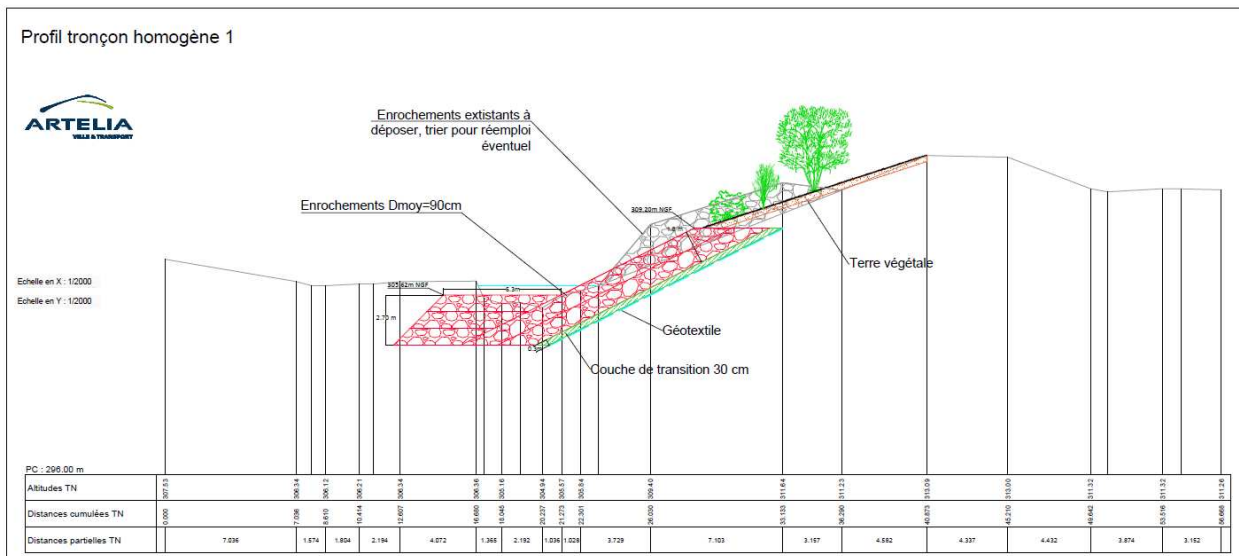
Profil en travers de la protection de berge (amont cf PT1 Figure 54)
